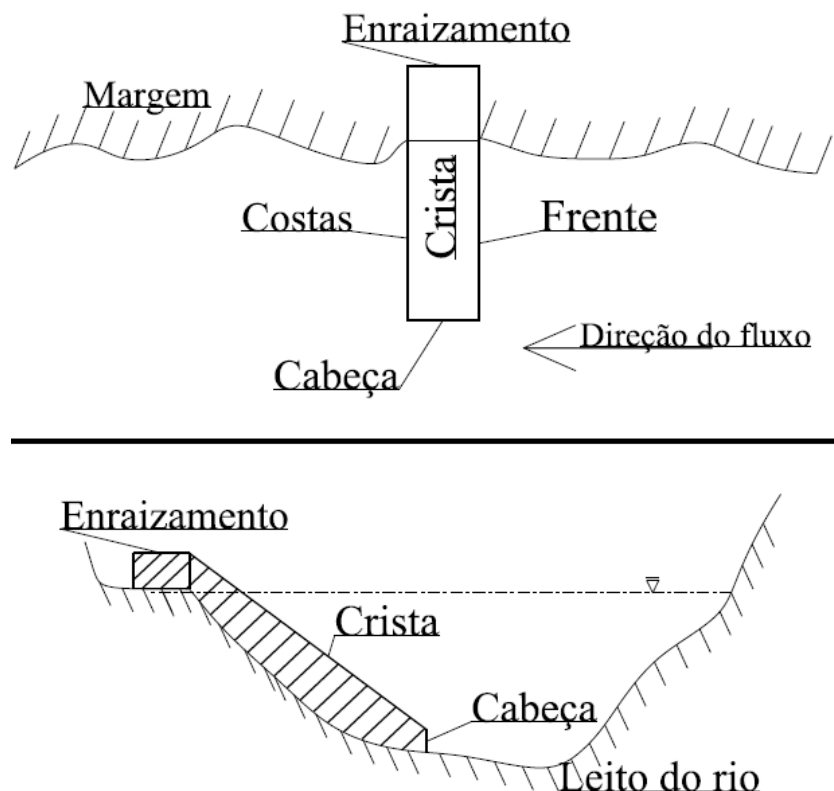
Estruturas do espigão em planta (superior) e em corte (inferior).
